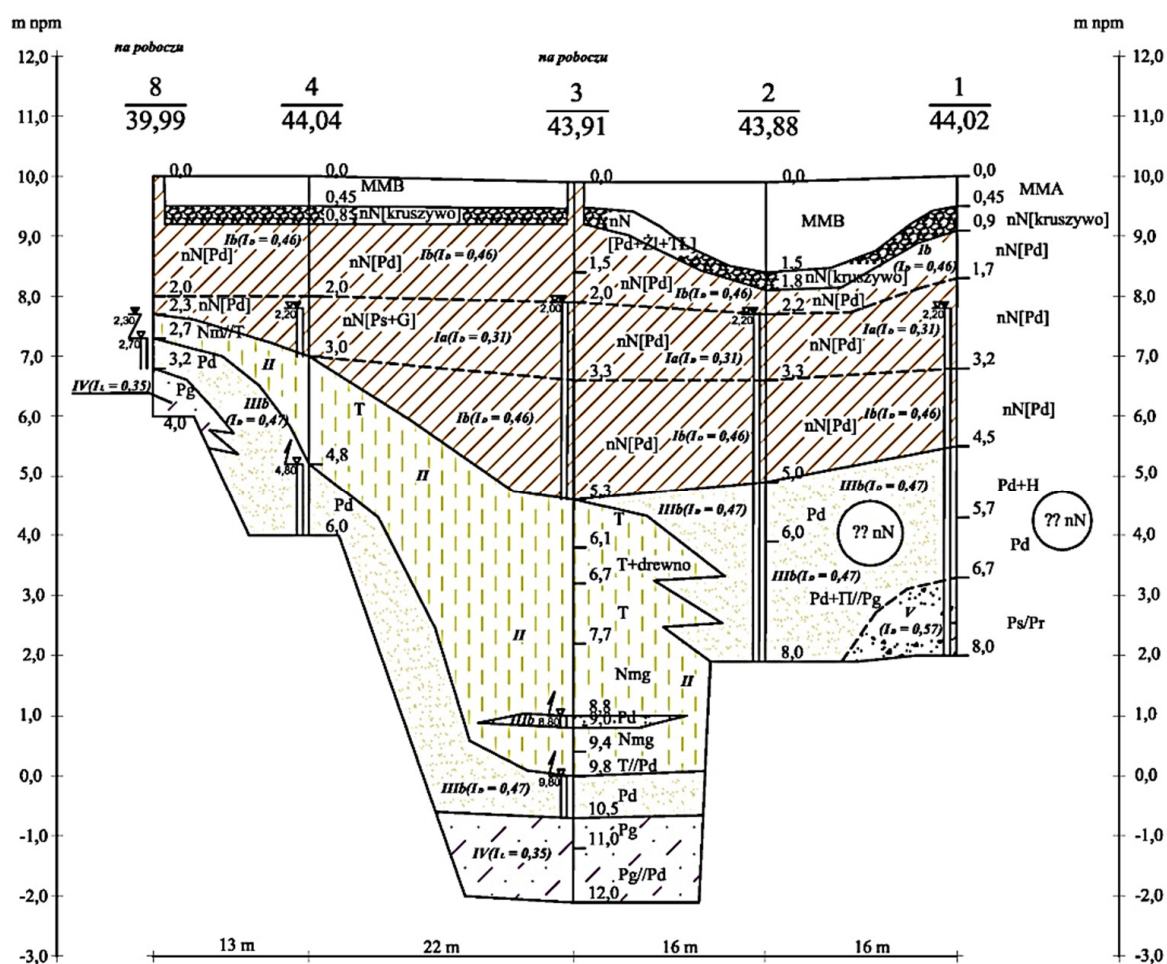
Przekrój geotechniczny przy podstawie nasypu kolejki
